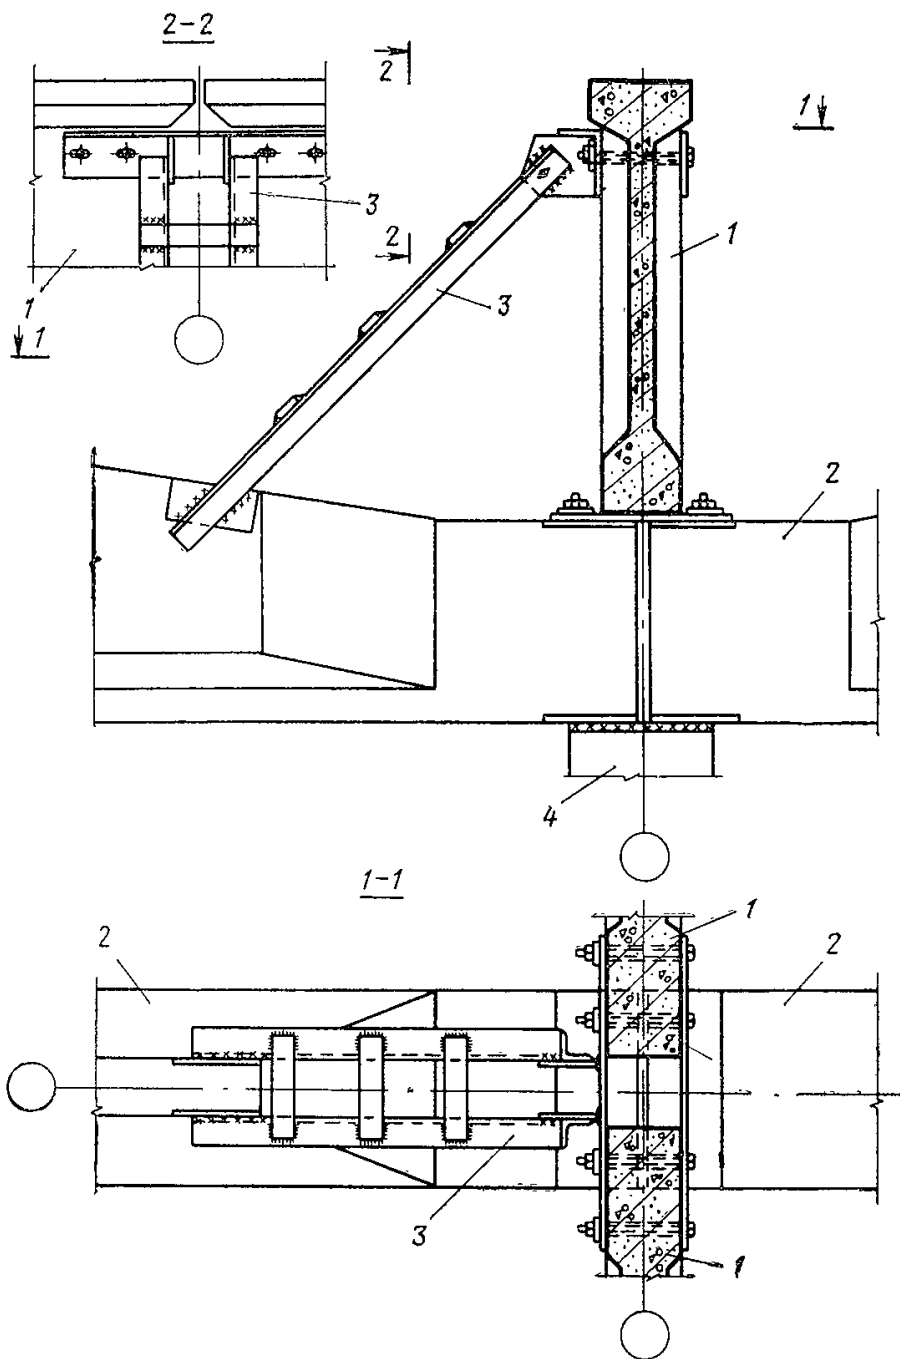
Крепление стропильных балок к подстропильным в месте опирания их на колонну (при плоской кровле) в зданиях с расчетной сейсмичностью 8 баллов
